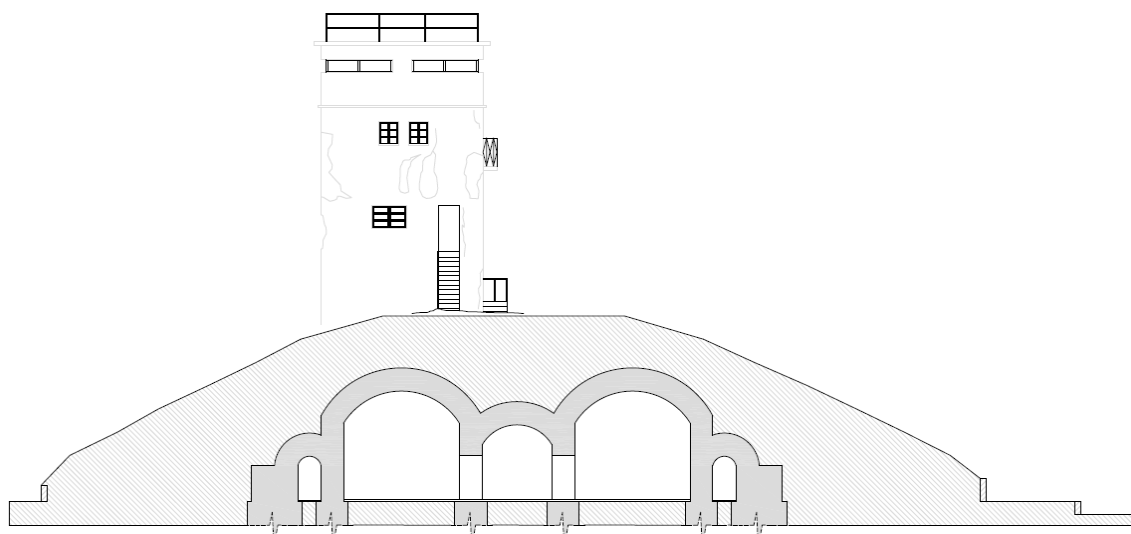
Sección longitudinal de las bóvedas del polvorín. Planos cedidos por Trasatec Sevilla 2008.
